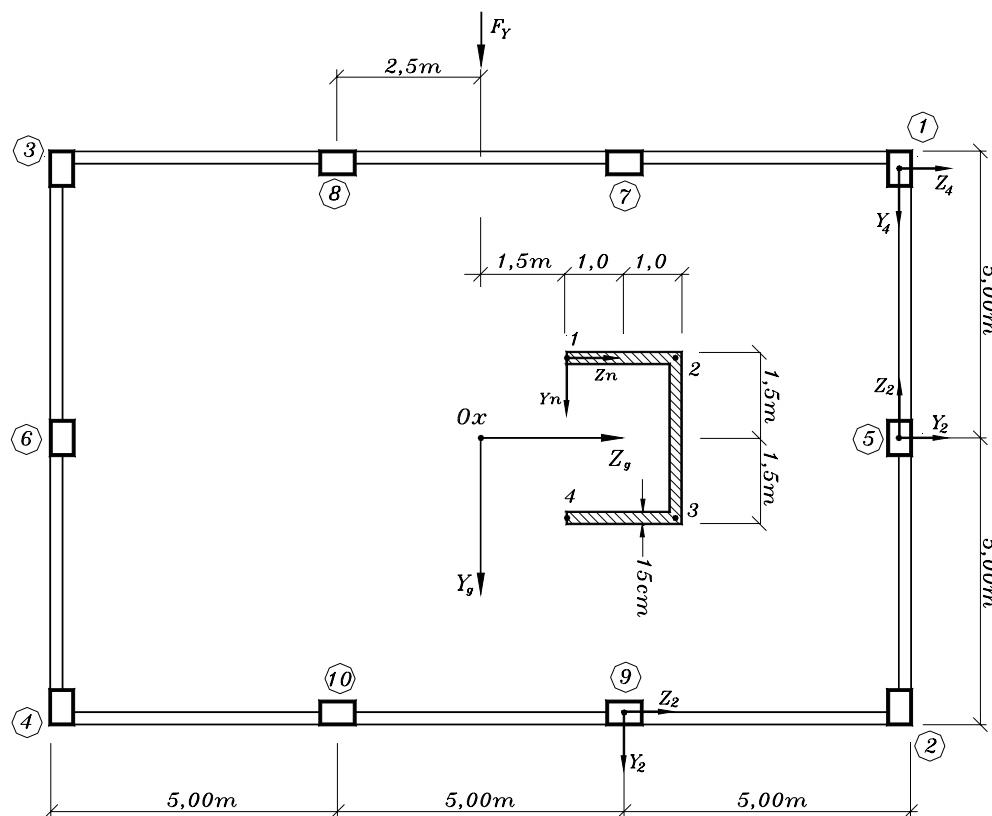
Planta baixa da estrutura de contraventamento idealizada por SILVA (1989).
